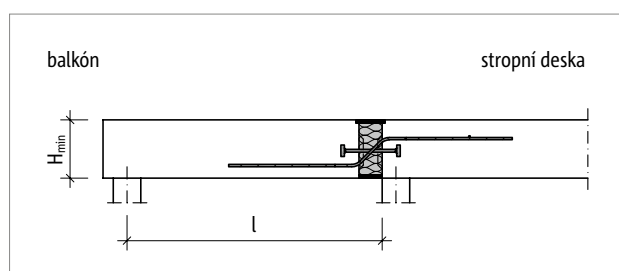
Schöck Isokorb® T typ QL-VV2 až VV6: Statický systém
